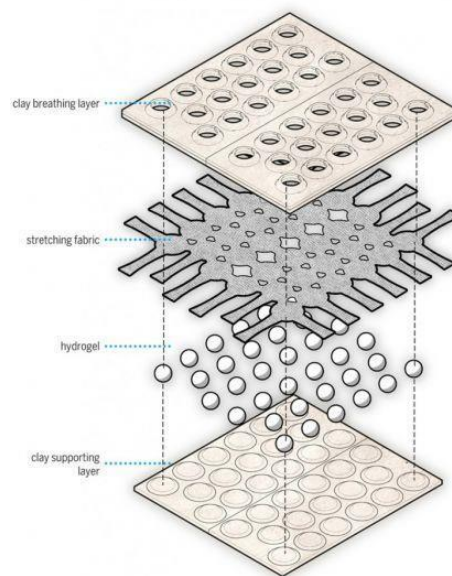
Estructura Sándwich de los ladrillos inteligentes
